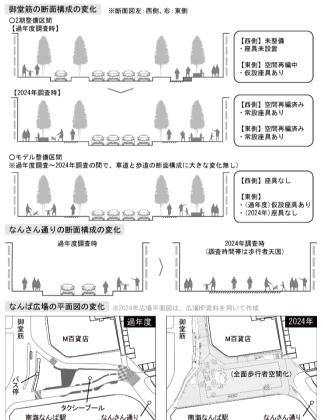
人中心の空間整備が行われた地点の 各調査段階での断面図、平面図
